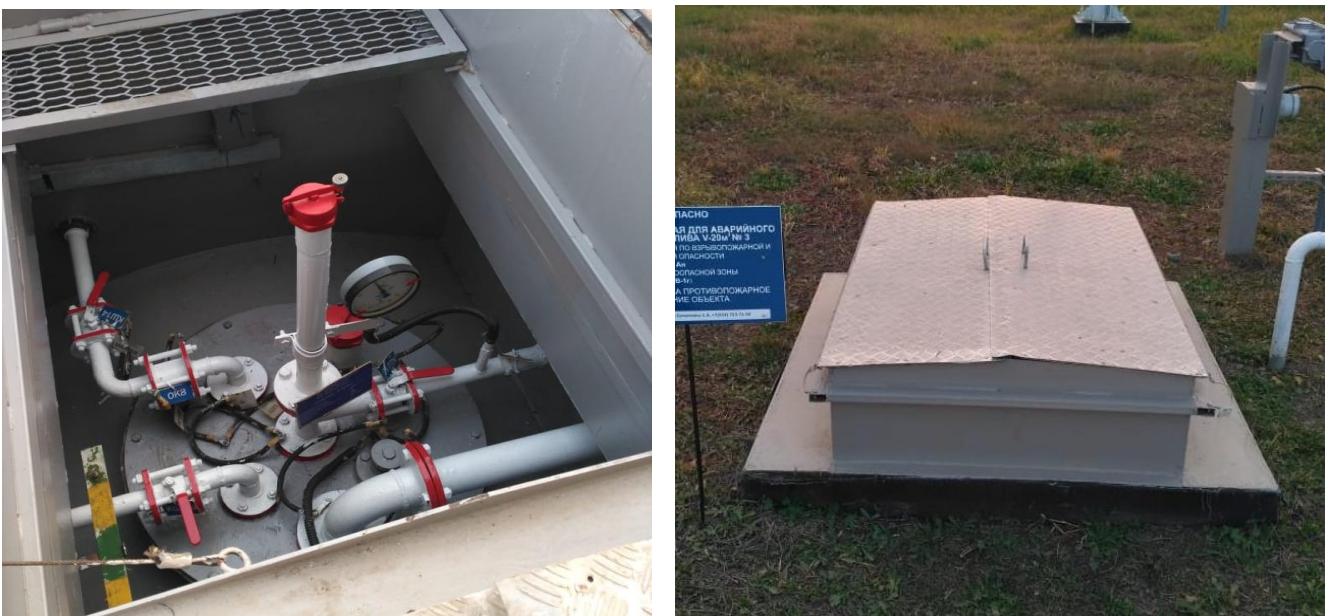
Общий вид видимой части конструкции резервуара РГС-20 № 635
